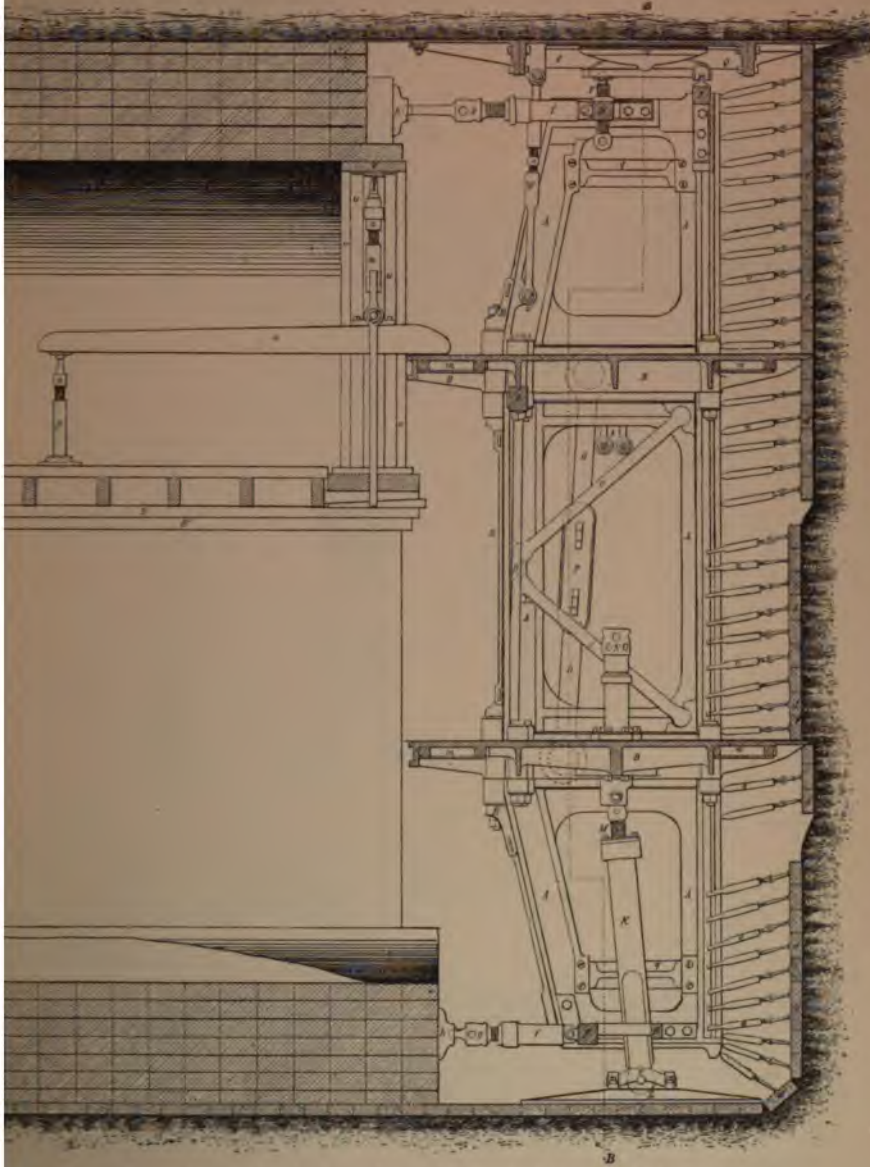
Coupe longitudinale du cadre n° III sur la ligne AA de la figure 9.
